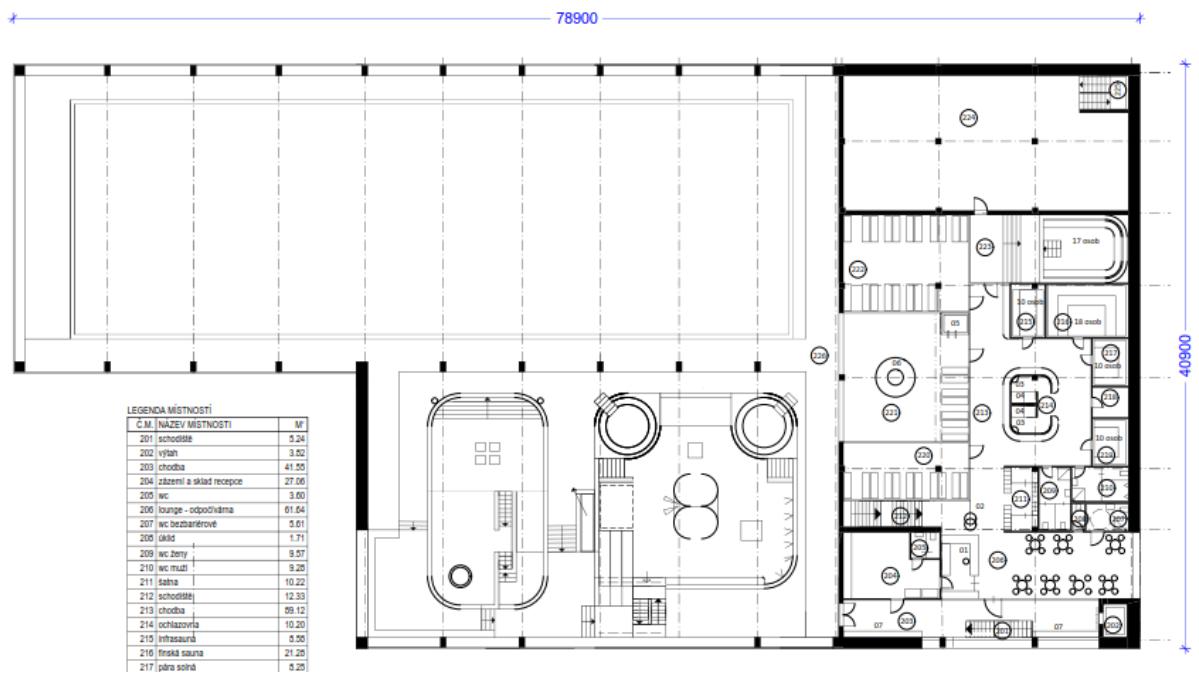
Půdorys 1.PP – 25 m bazén (zdroj: Šumavaplan projekt s.r.o.)
